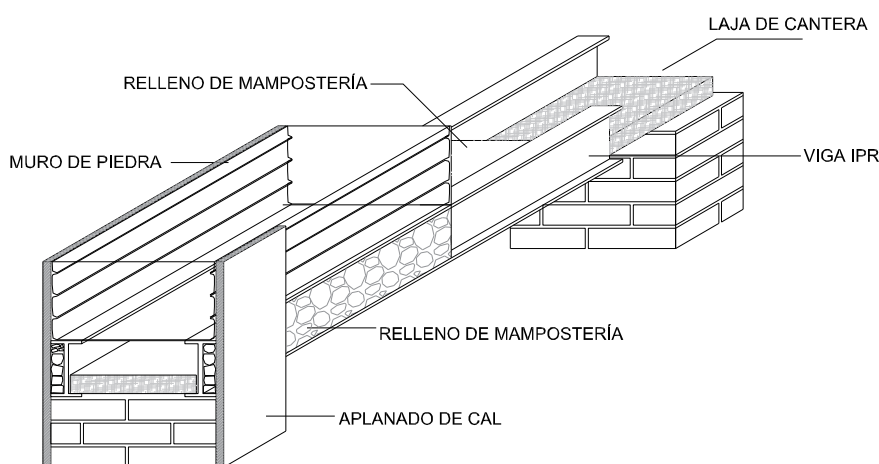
Detalle constructivo de viguetas dobles.
